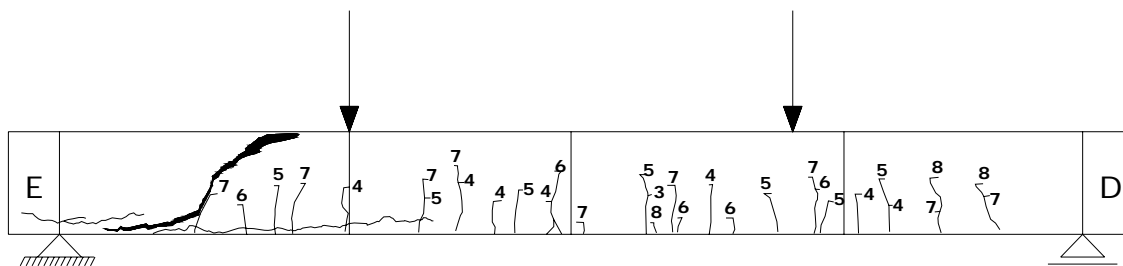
Padrão de fissuração para a viga V70-1.1 sem armadura transversal
